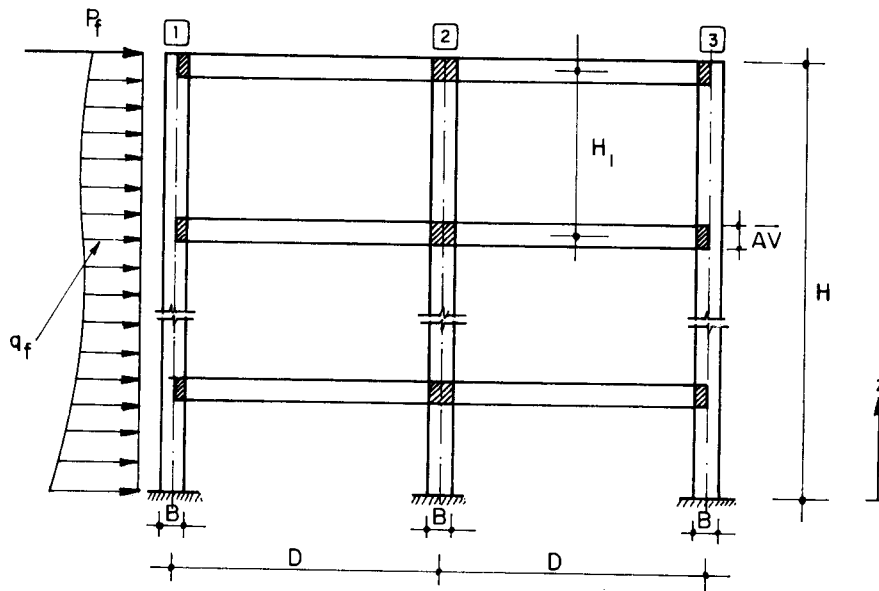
Painel com três pilares de pórtico unidos por vigas
